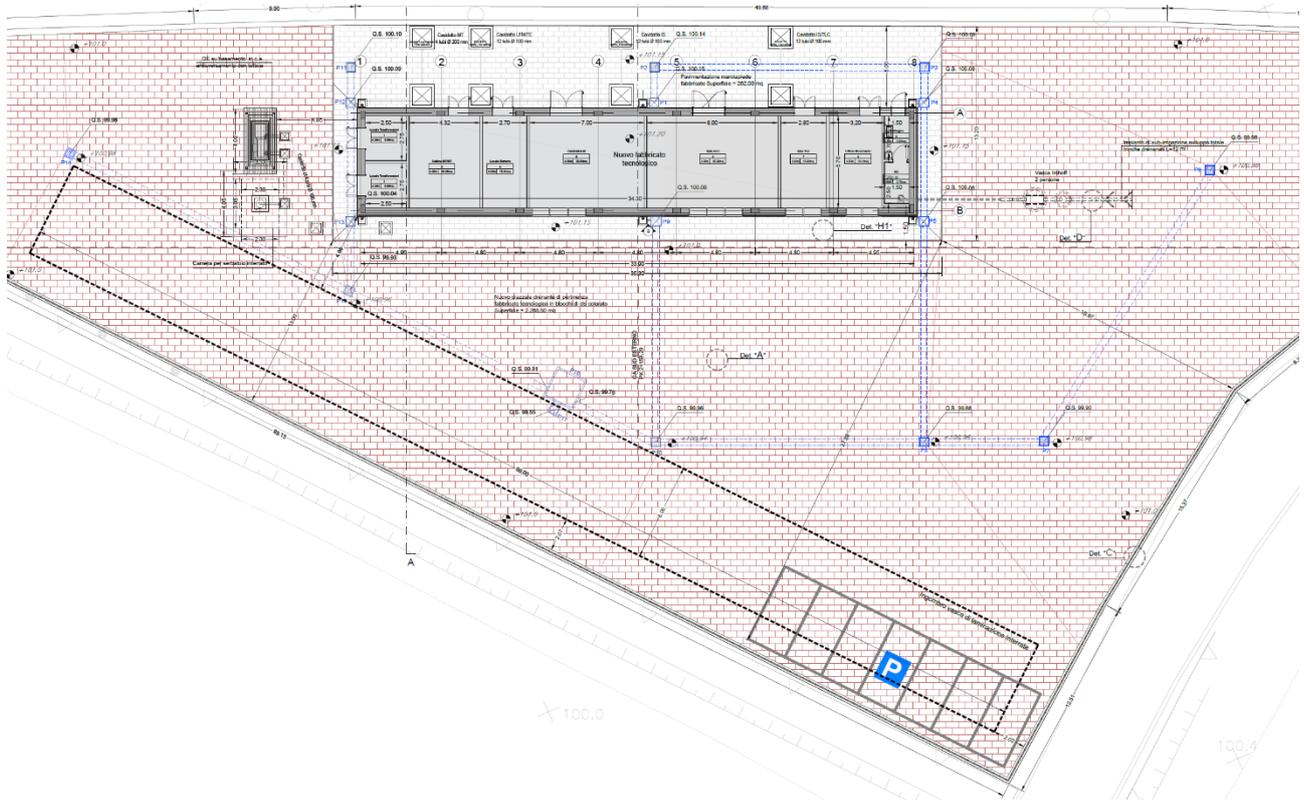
GA Sud Esterno - Estratto della planimetria idraulica
